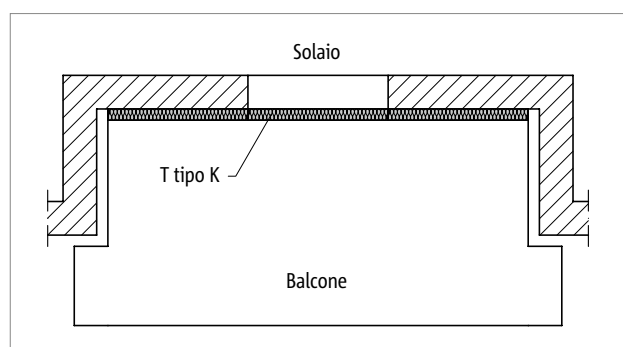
Schöck Isokorb® T tipo K: balcone con elemento rientrante nella facciata
